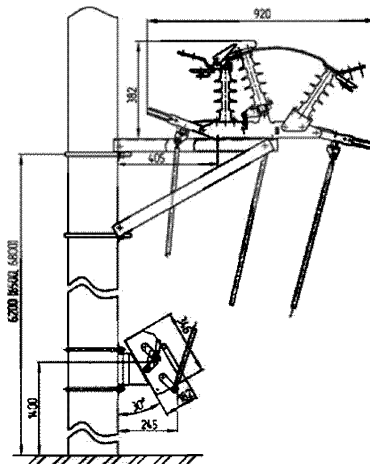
Размерный эскиз. Установка РЛК-2-10.IV/400yXA1 с приводом ПР-7УХЛ1 на опоре
